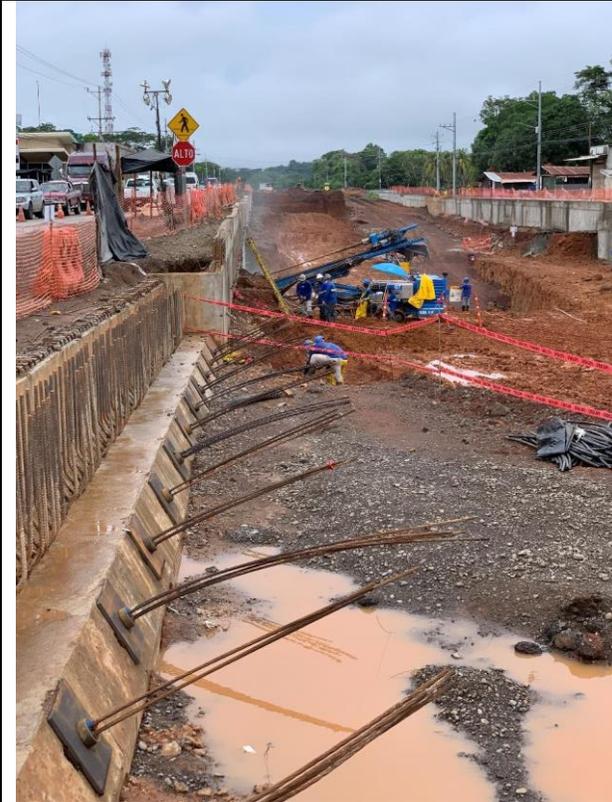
intercambio Limalón, Estructura de bastión para el paso elevado y construcción de muro tipo soil nailing.
